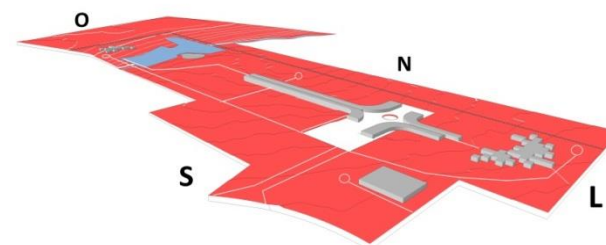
Esquema de implantação das edificações no Plano UMA.
